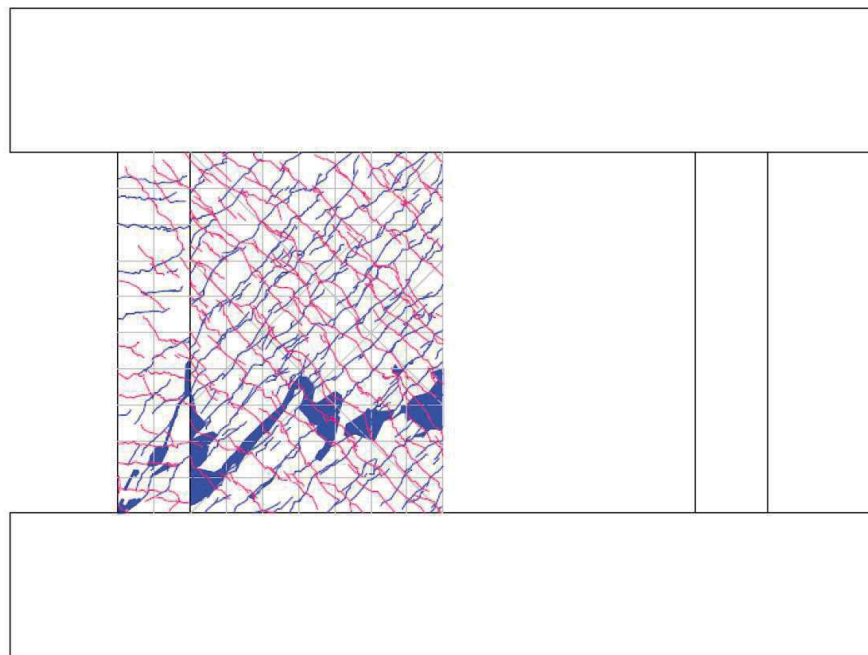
試験体 S-13-D0 最終破壊時ひび割れ図
